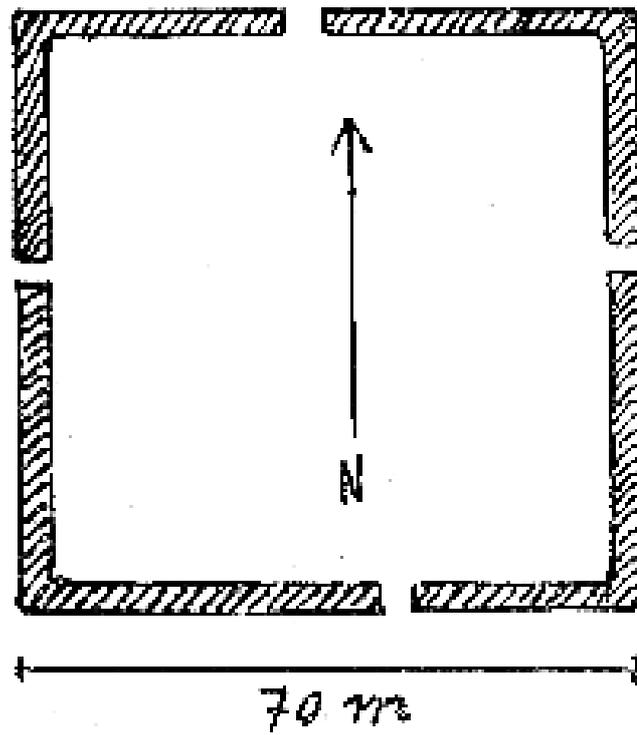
Alteburg, Grundriß nach Hopstädter (wie Anm. 10)
